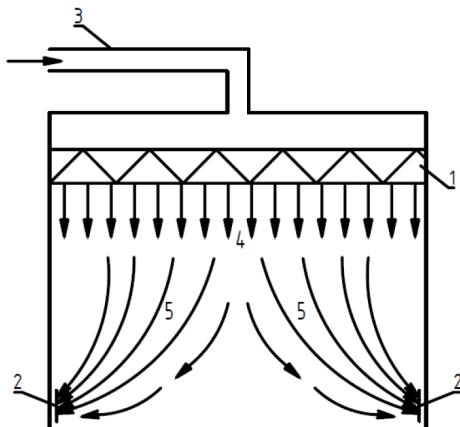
Вентилирование помещения вертикальным односторонним потоком с удалением воздуха через вентиляционные решетки, расположенные вдоль стен: 1 – потолочный воздухораспределитель одностороннего потока; 2 – вытяжное отверстие или вытяжные вентиляционные решетки; 3 – приточный воздуховод; 4 – односторонний поток воздуха; 5 – неодносторонний поток воздуха
